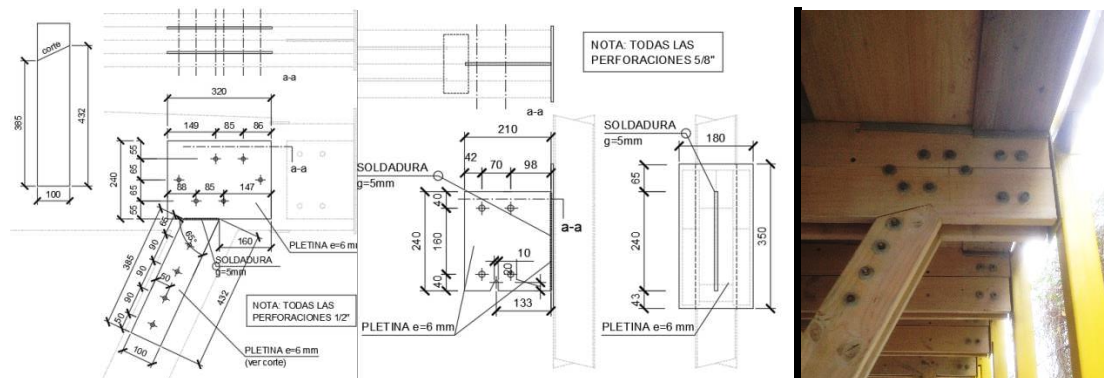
Configuración de uniones de viga principal: encuentro viga principal- tirante-diagonal y viga principal-parrilla metálica. Notar protección entre carpeta superior y viga.
